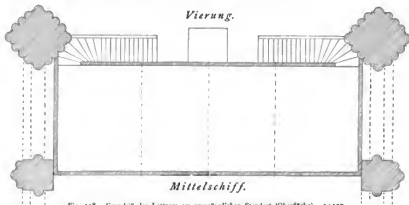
Grundriß des Lettners am ursprünglichen Standort (Oberflüße). 1:100
